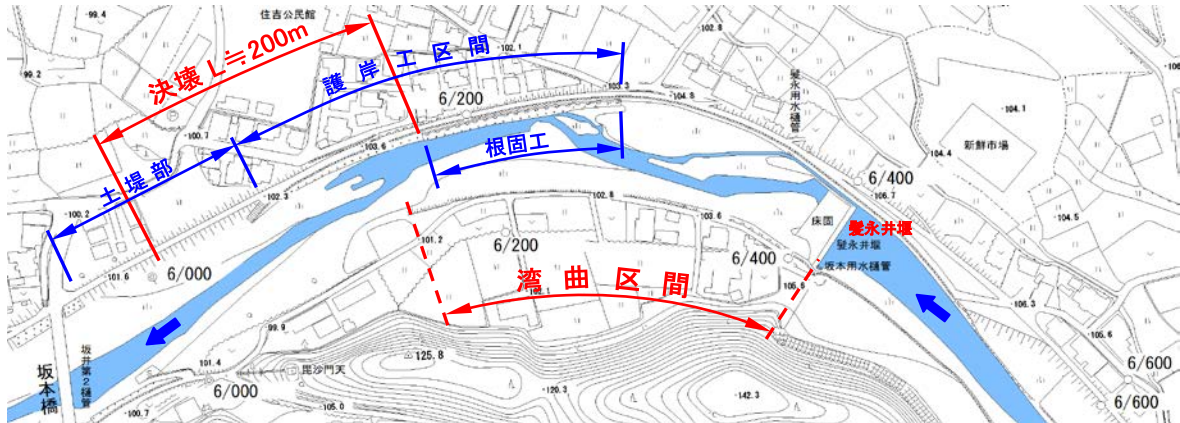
花月川6km付近被災前平面図 (筑後川河川事務所提供 ; H21年度測量平面図)
